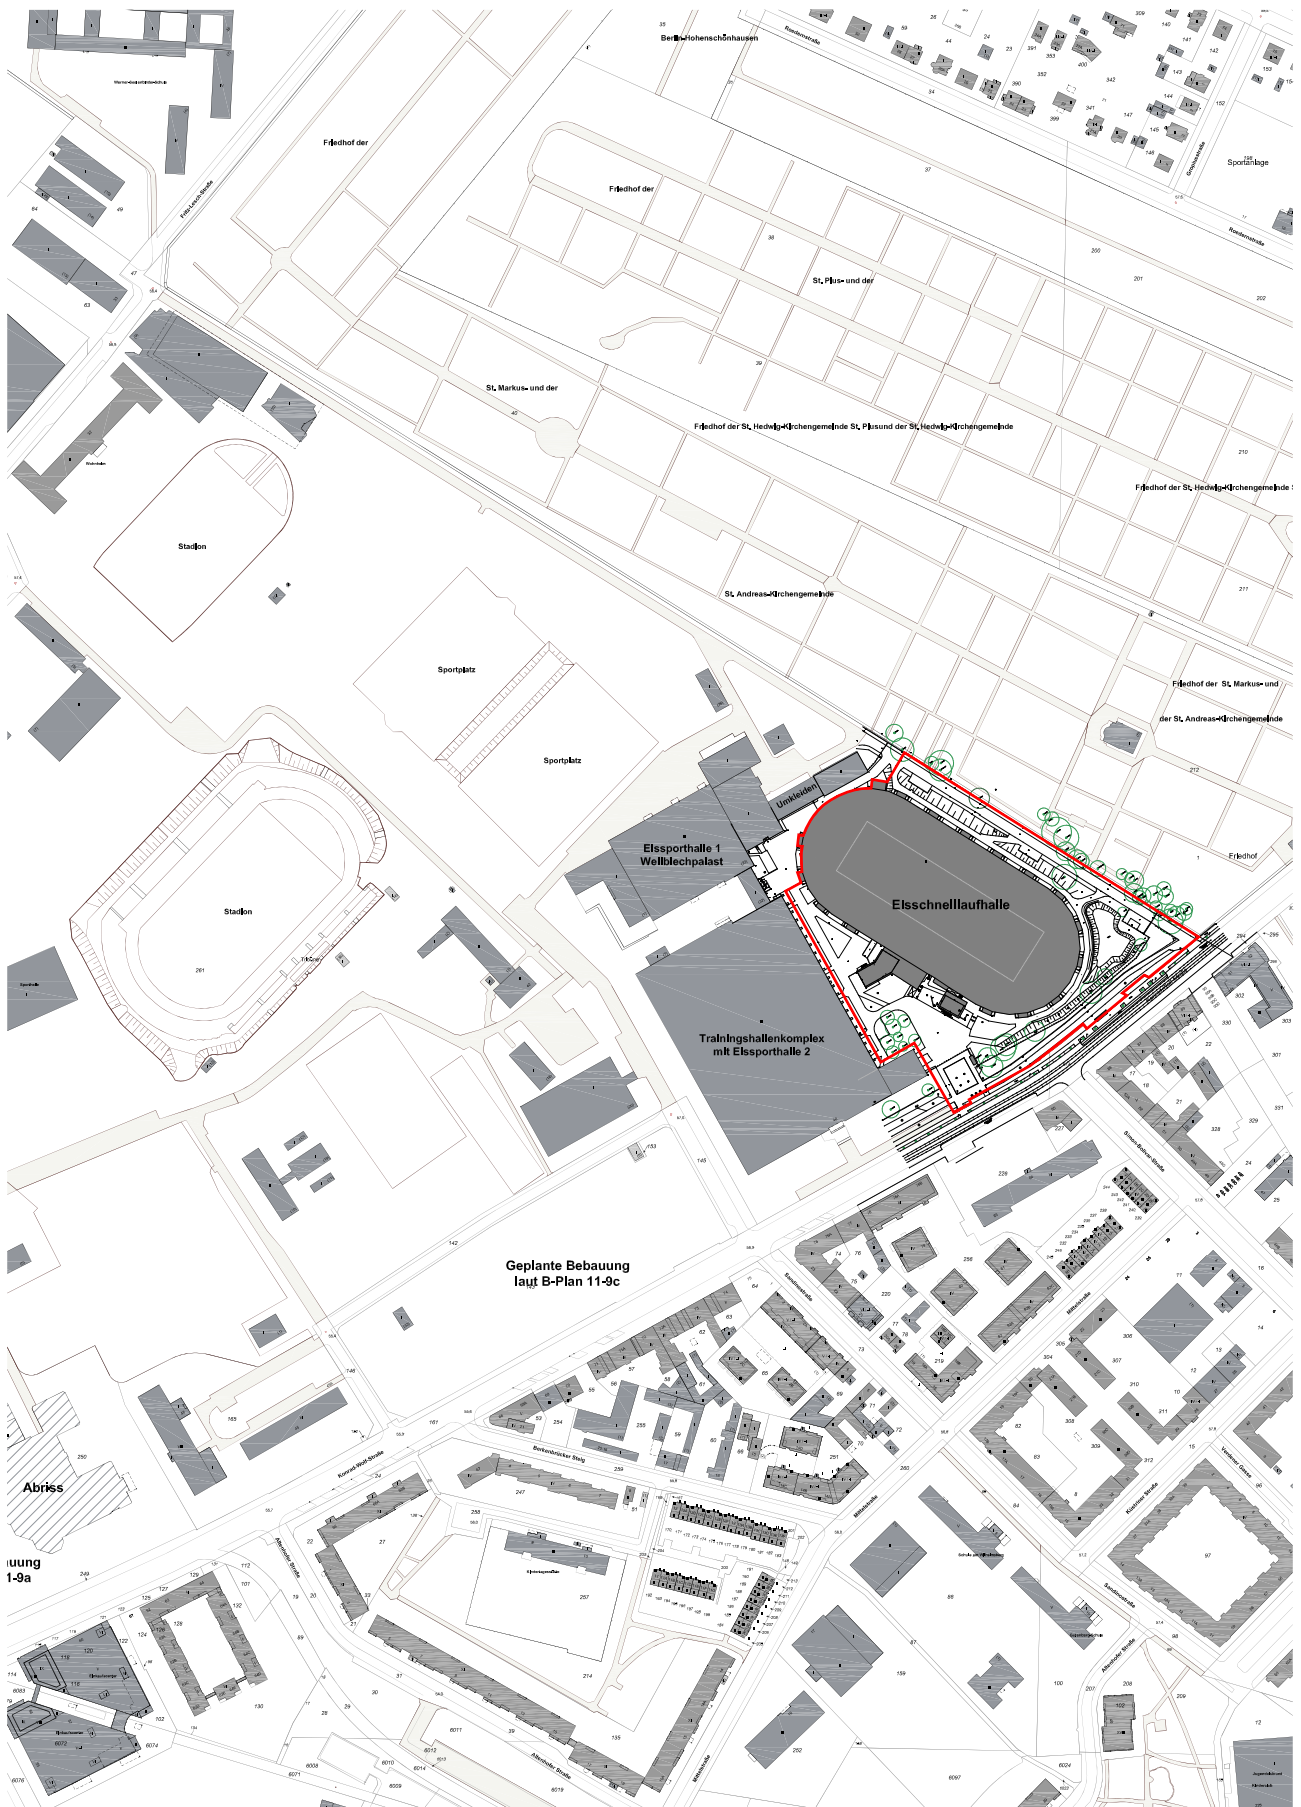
Lageplan mit Markierung des Wettbewerbsbereichs
